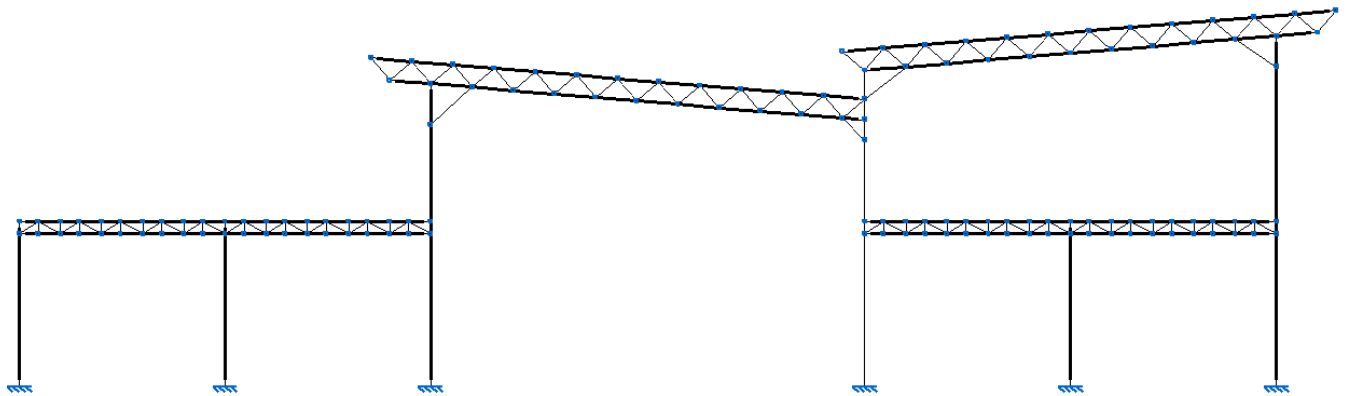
Geometría Modelo CYPE 3D – barras Vista Norte
